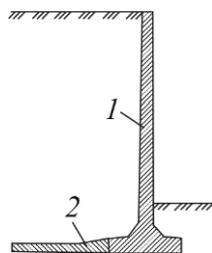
Конструкция подпорной стены с использованием универсальной стеновой панели: 1 – универсальная панель стеновая (УПС); 2 – монолитная часть подошвы
